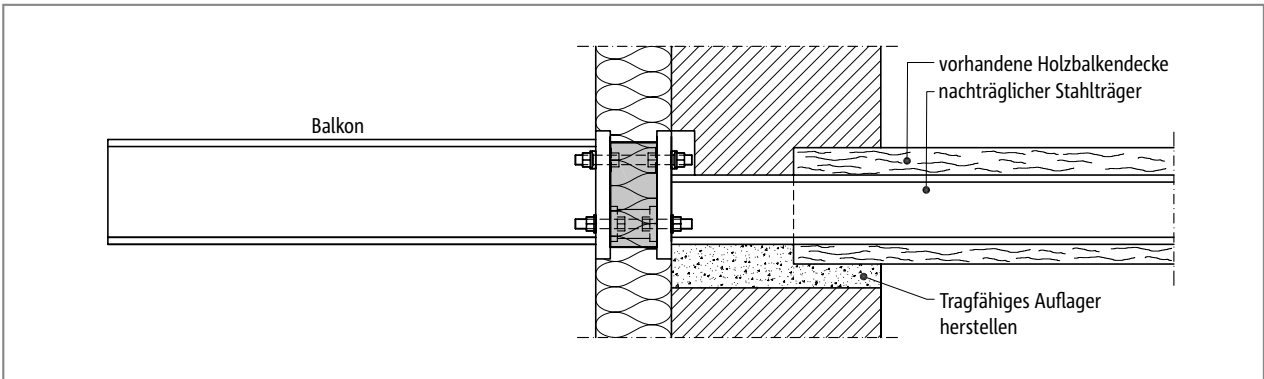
Schöck Isokorb® T Typ S: Stahlbalkon frei auskragend; angeschlossen an Holzbalkendecke
